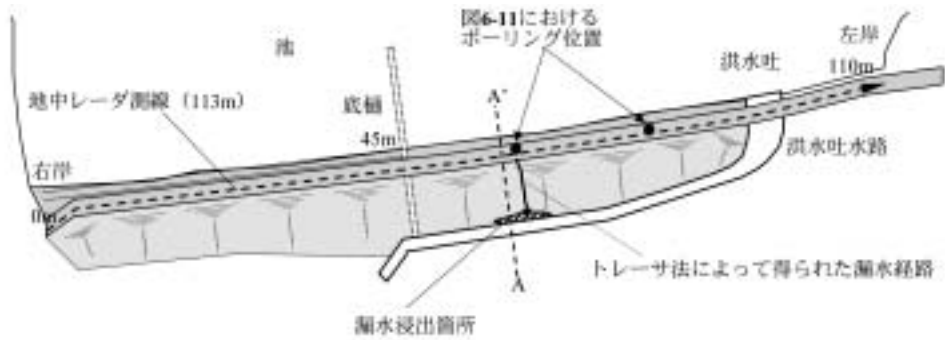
調査ため池平面図 (地中レーダ測線・ボーリング位置)
